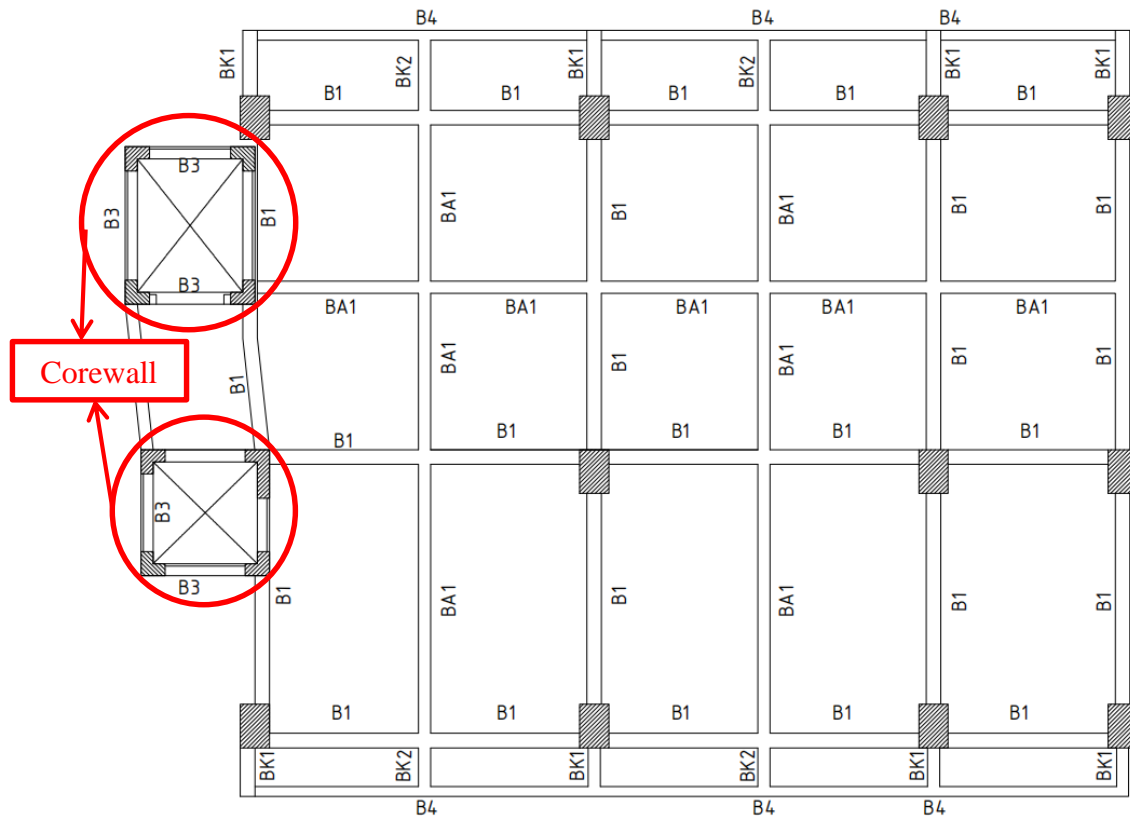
4 Denah Struktur Gedung Lantai 3
